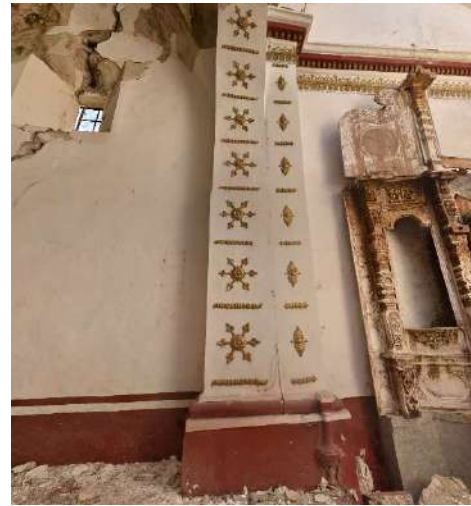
Pilastra Sur de Presbiterio Vista Frontal
